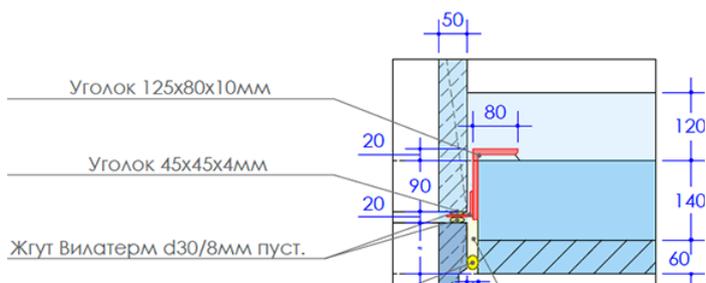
Архитектурно-конструктивный узел размещения вентиляционного блока
